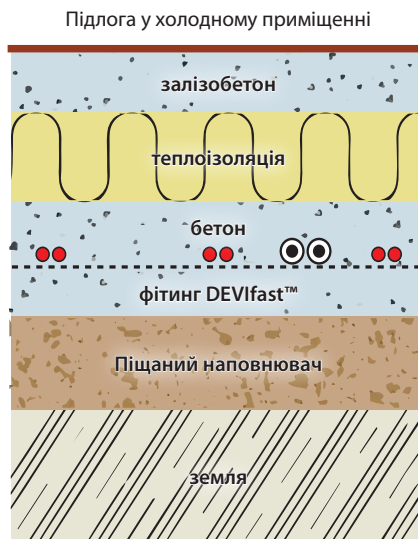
Нагрівальний кабель у бетонній стяжці
